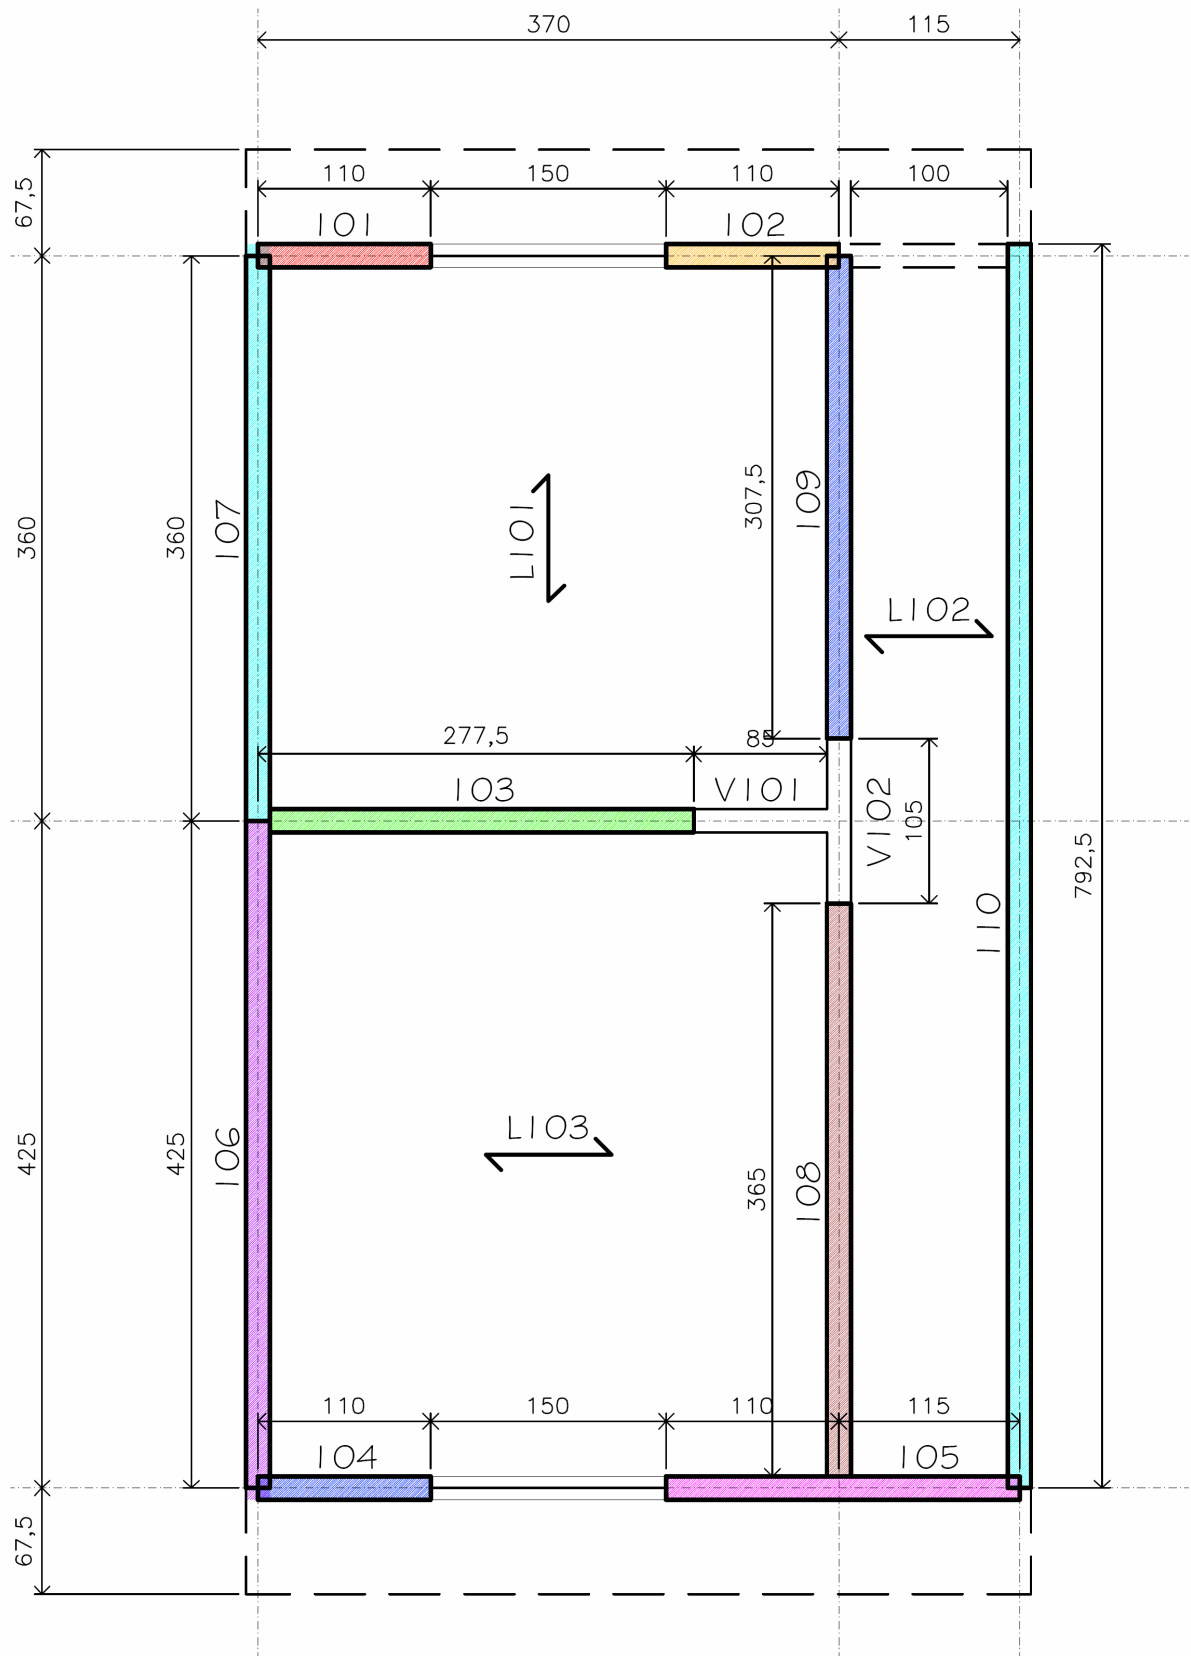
Estrutura do Exemplo J: pavimento superior
